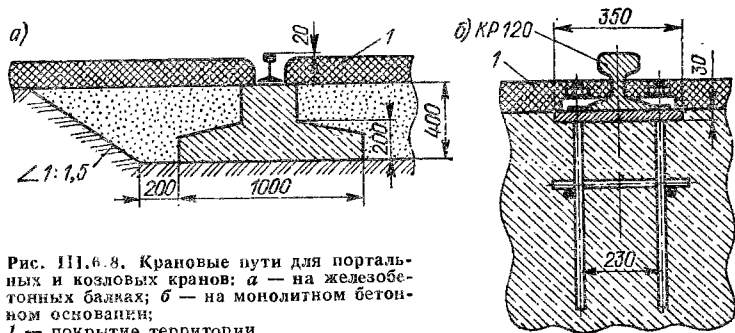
Крановые пути для порталных и козловых кранов: а — на железобетонных балках; б — на монолитном бетонном основании; 1 — покрытие территории
